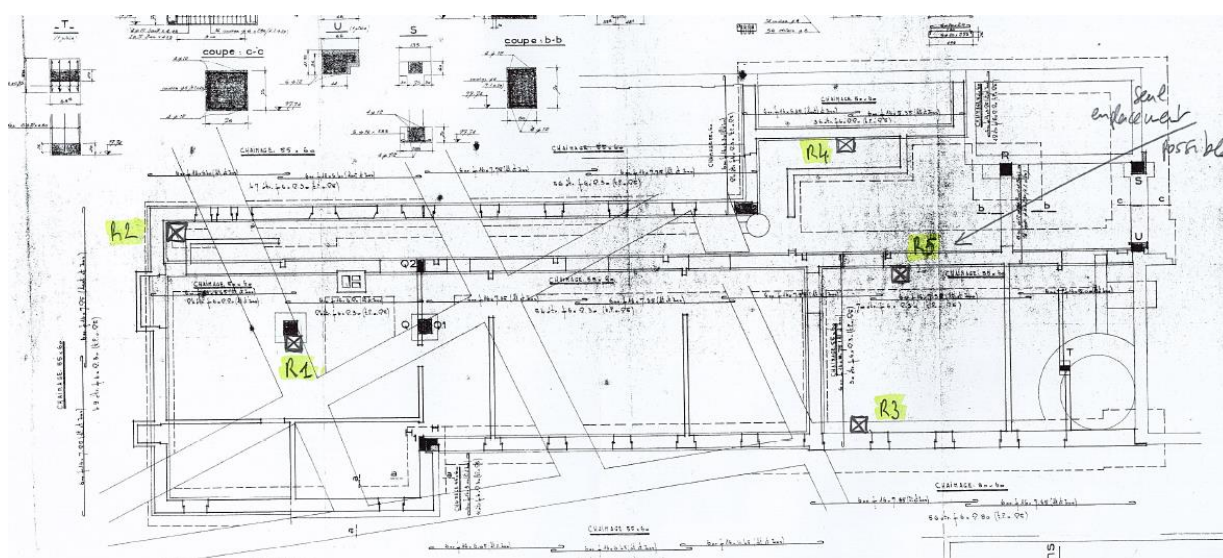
Implantation des reconnaissances des fondations au sous-sol du bâtiment Saône
